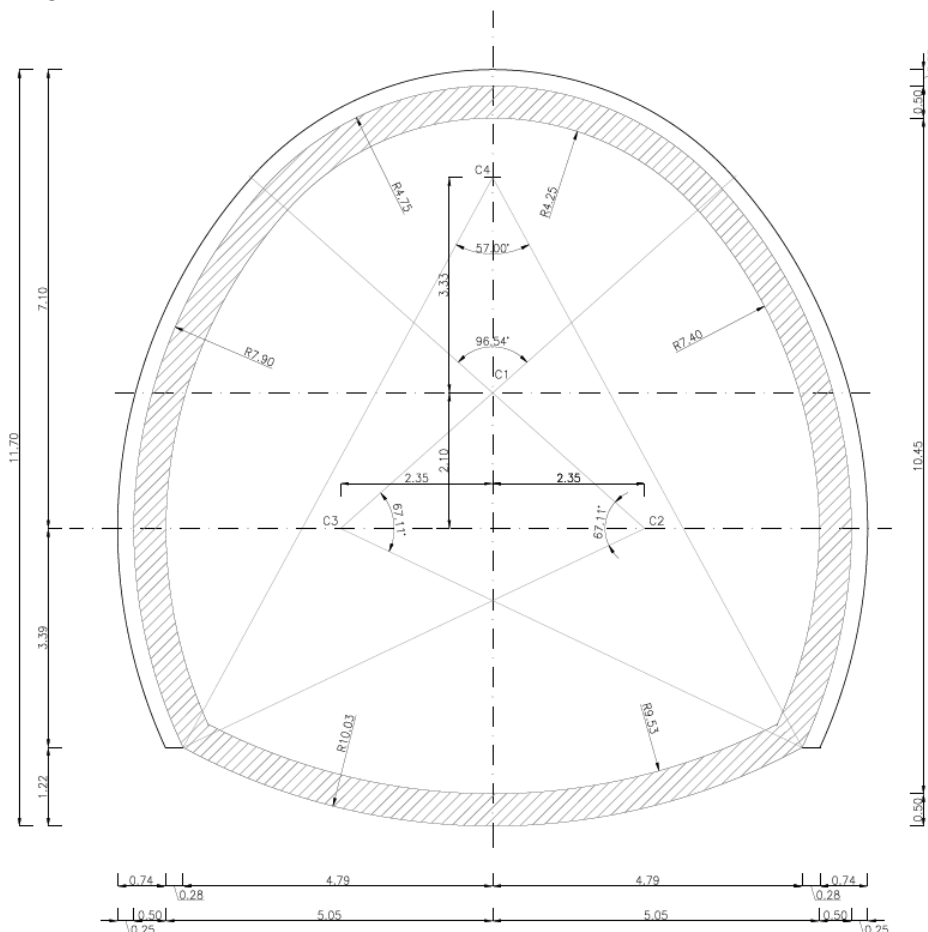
Sezione tipo della galleria di accesso alla centrale
